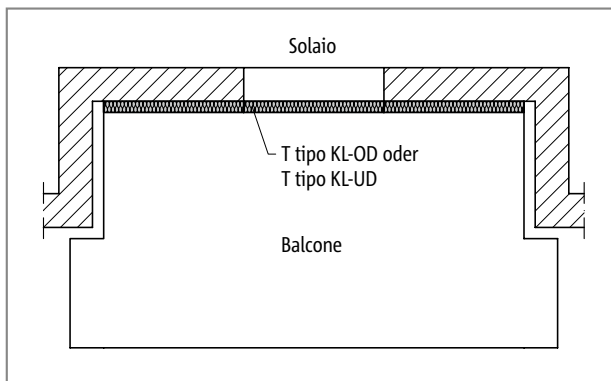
Schöck Isokorb® T tipo KL-OD/KL-UD: balcone con elementi rientranti nella facciata
